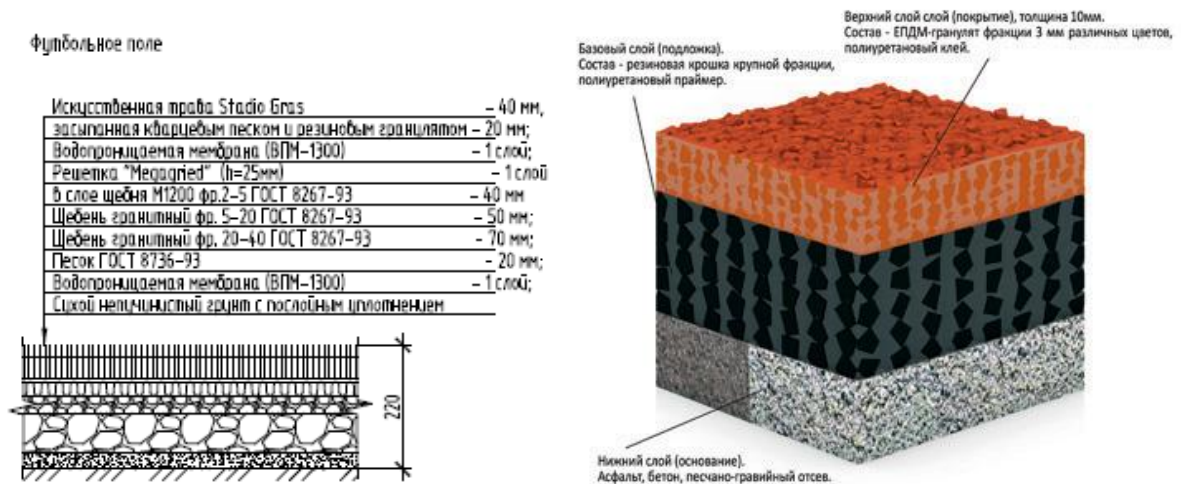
Футбольное поле (искусственный газон). Монолитное бесшовное резиновое покрытие из резиновой крошки
